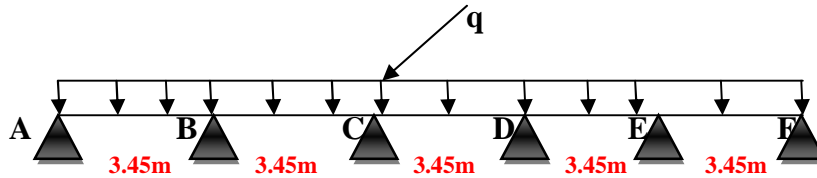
Schéma statique de la poutrelle T1 (terrasse inaccessible)
